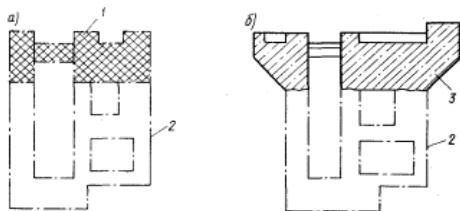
Фундамент с измененной верхней частью. а, б - фундамент до и после реконструкции соответственно; 1 - разрушаемая часть сущ. фундамента; 2 - используемая часть сущ. фундамента; 3 - новая часть фундамента
